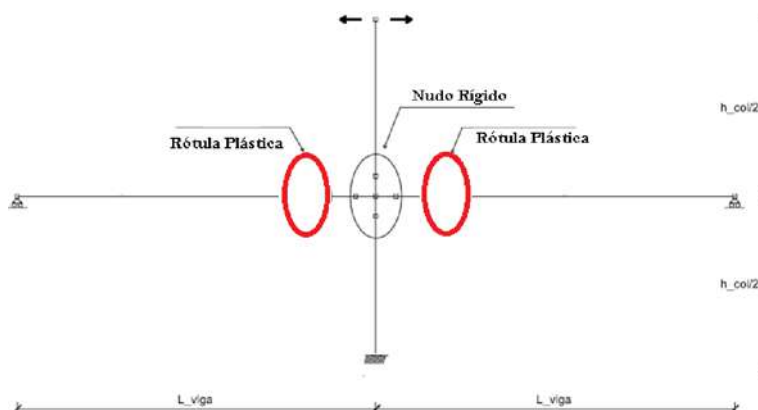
Rótulas en las vigas adyacentes a la columna
